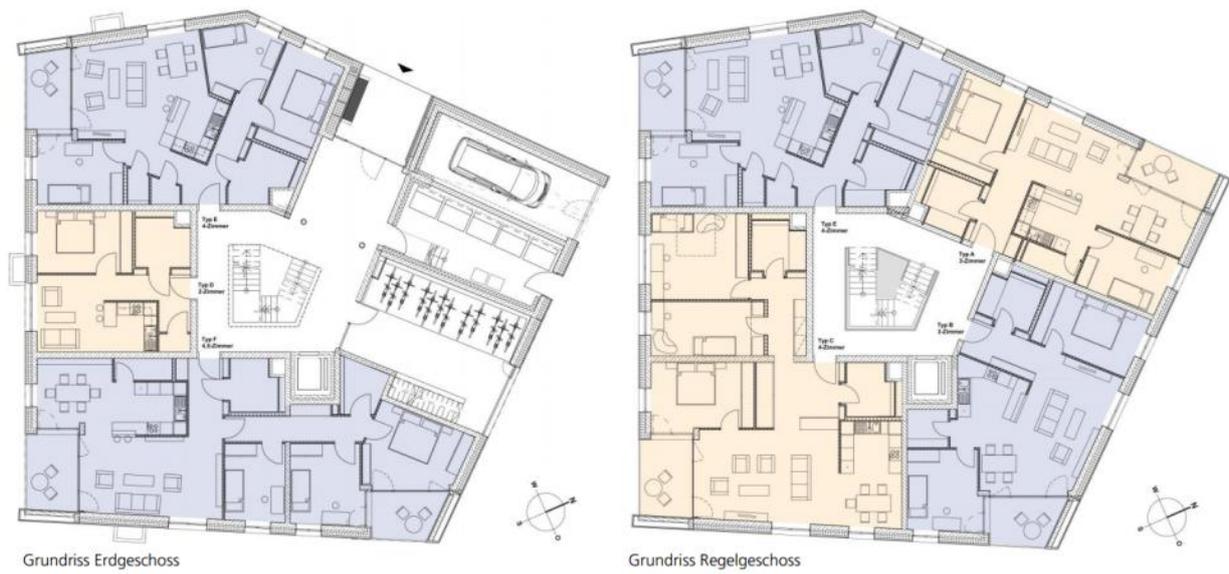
Grundrisse Erdgeschoss und Regelgeschoss aus [2]
